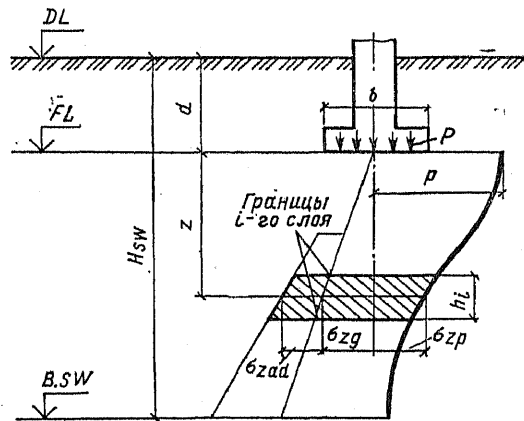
К расчету подъема фундамента при набухании грунта
